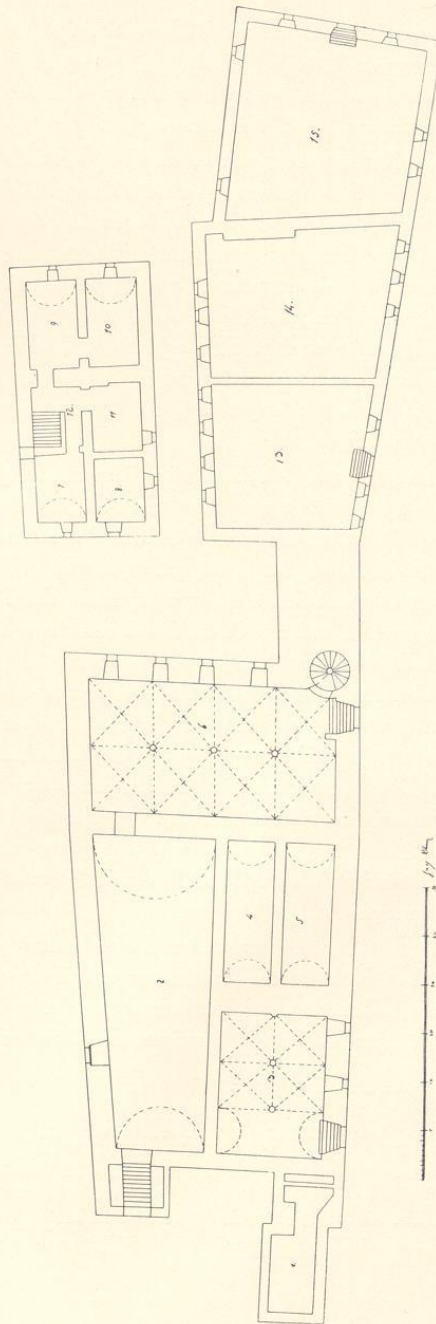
Grundriß des Kellergeschoßes der Städtischen Gebäude, um 1815
